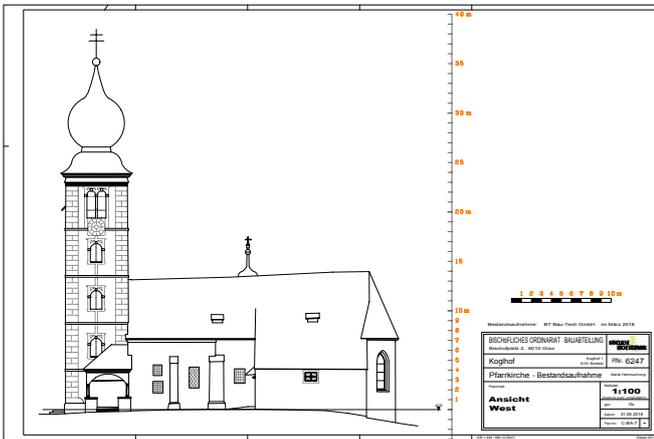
Pfarrkirche Koglhof – Planansicht – West umgesetzt. Beide Türme stimmen größtenteils in Fassadengliederung und Dachform überein.
